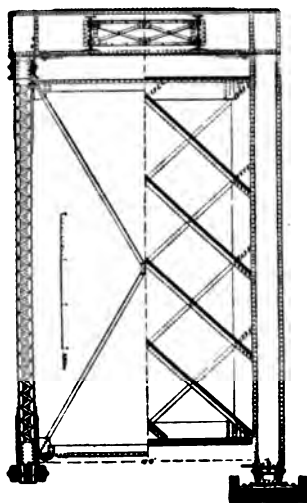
Pont de Cairo. — Travée de 75^m,90. — Demi-coupe et demi-élévation extrême.
